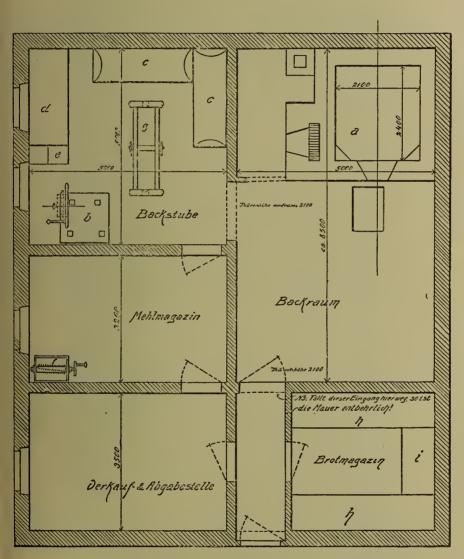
Grundriß einer Baderei mittleren Umfanges mit Maschinenbetrieb.
